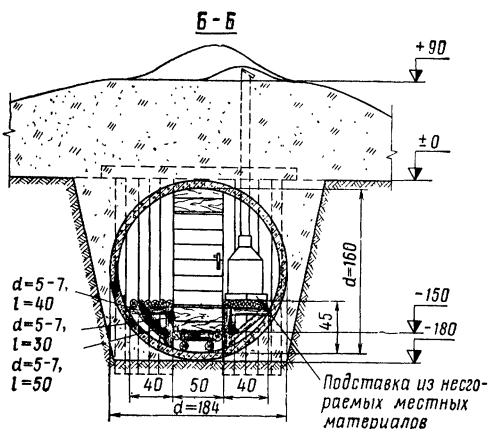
Блиндаж из железобетонной трубы и перемычек (разрез)
